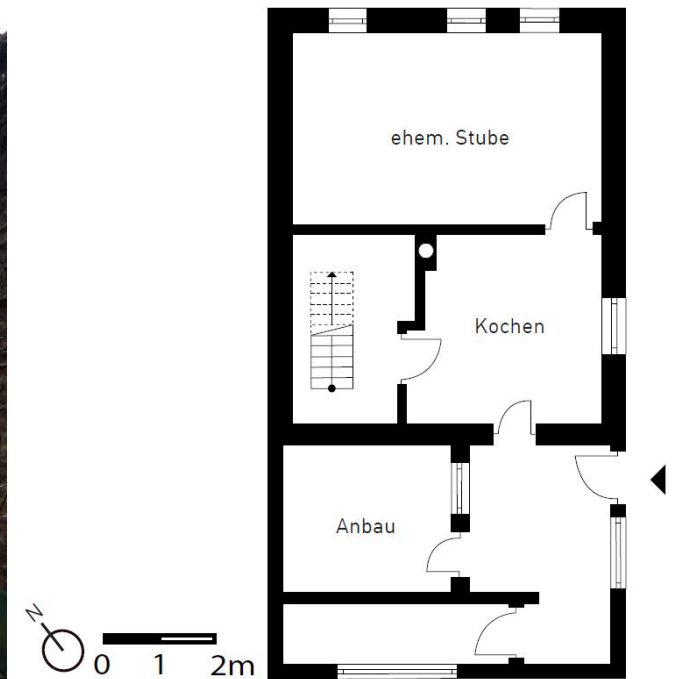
Erdgeschoss Grundriss, 2021.
